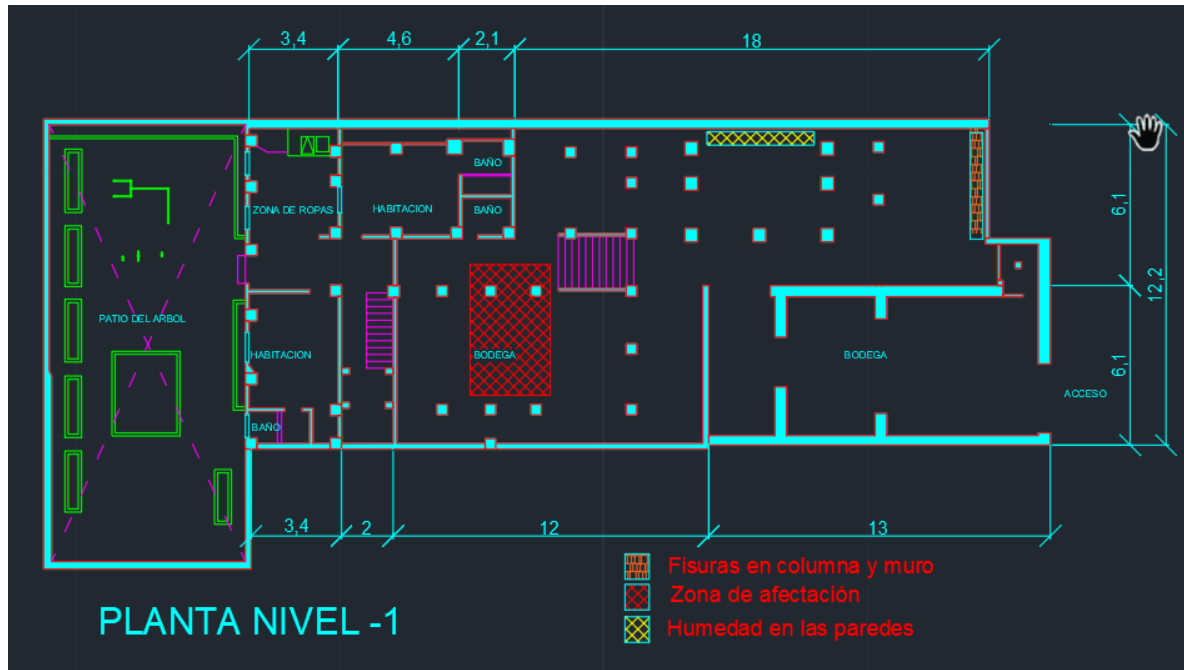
Plano arquitectónico planta baja. Elaborado por los autores. 2024.
